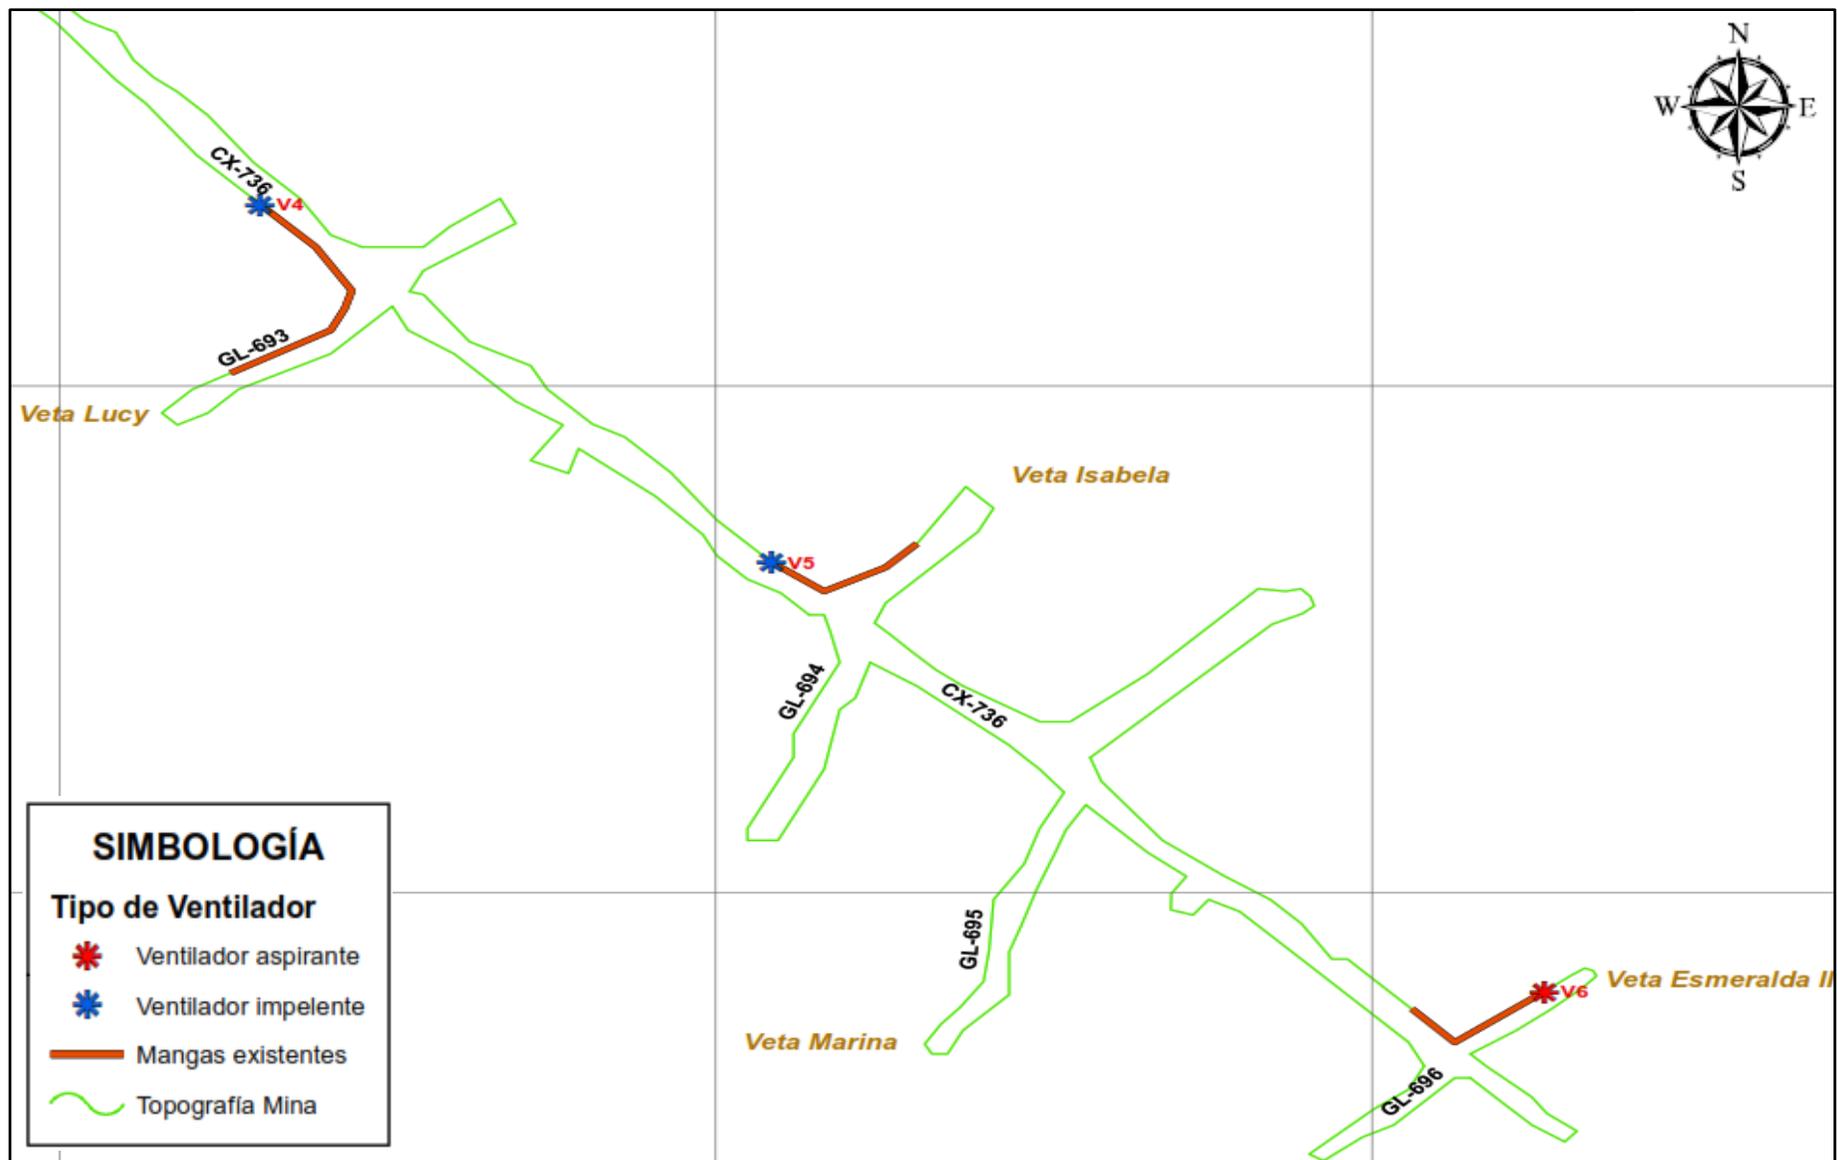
Vista del plano: Sistema de ventilación actual - zona Sur.
